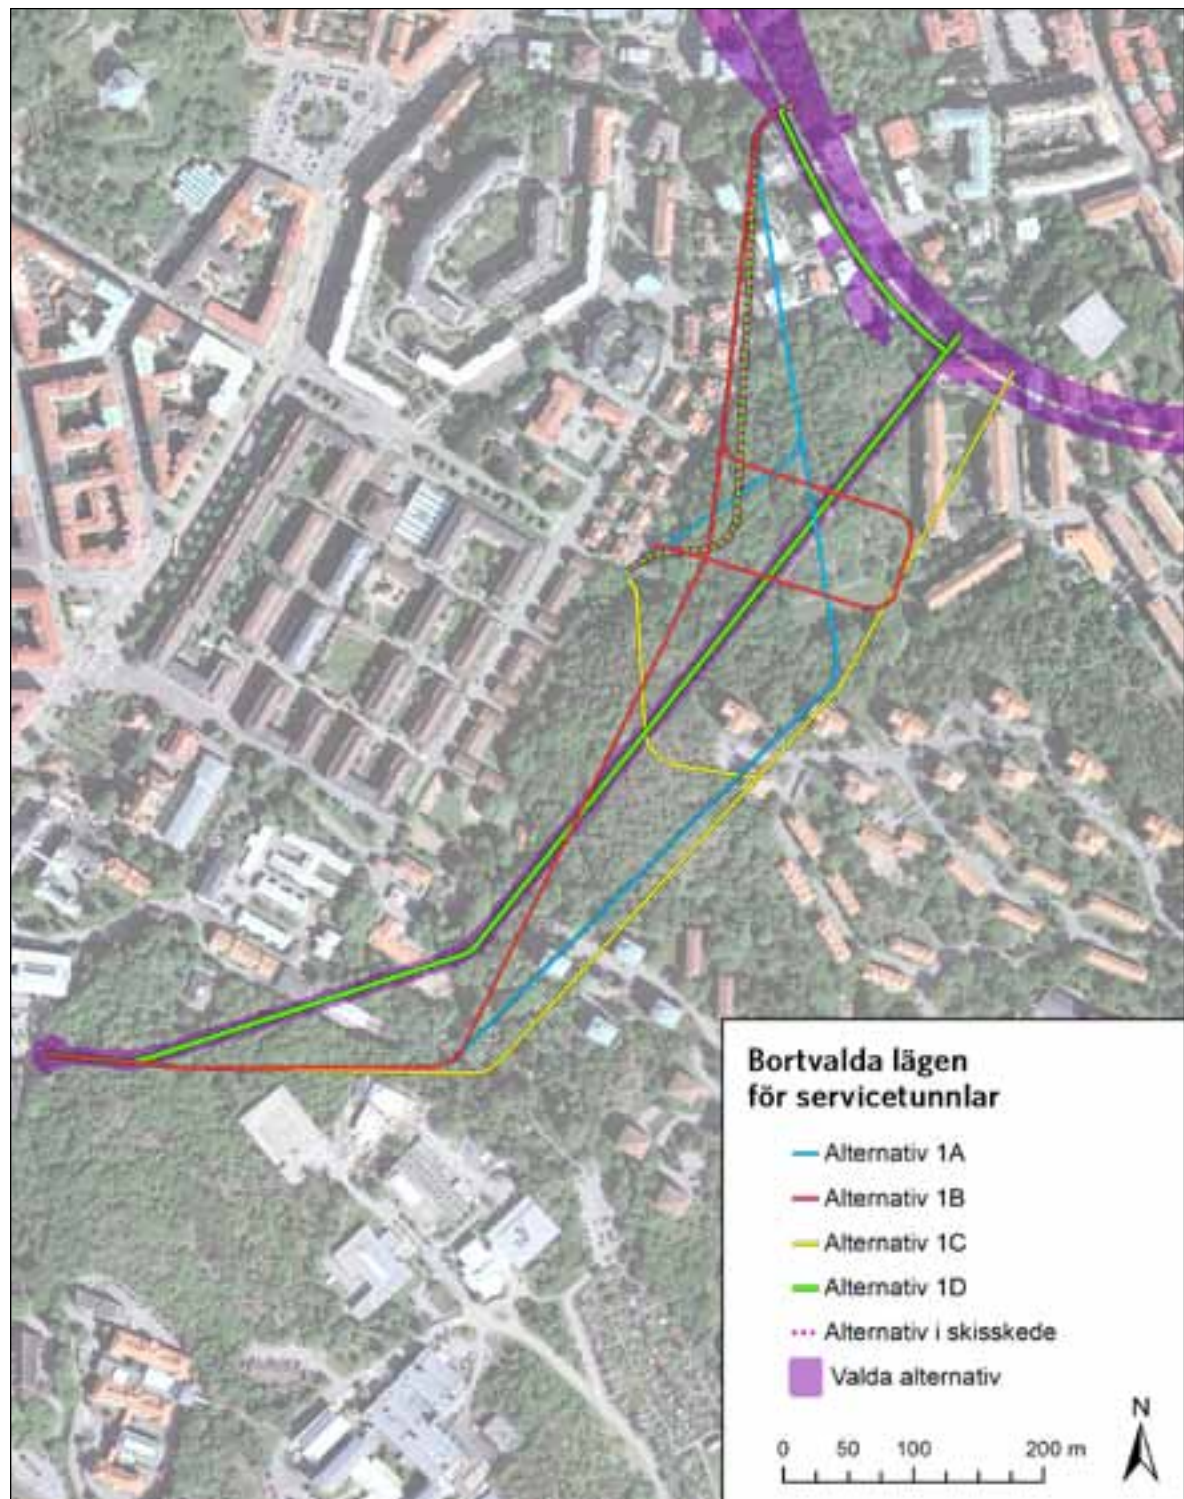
Bortvalda placeringar av tunnelmynningar till servicetunnel mellan Station Haga och Station Korsvägen.
